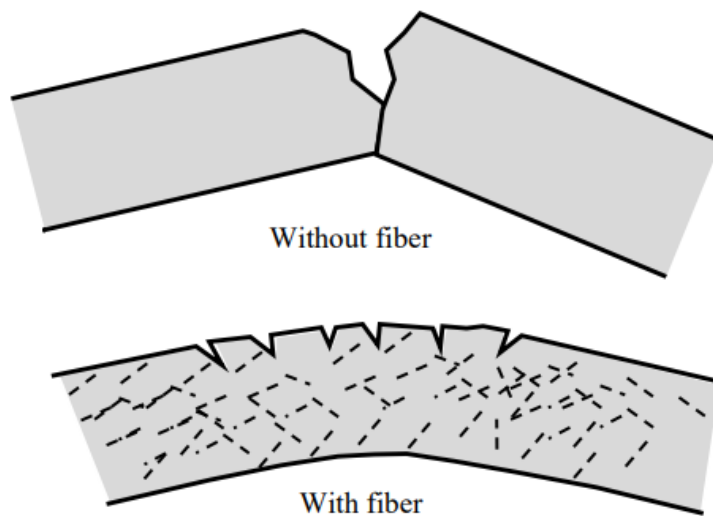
вплив волокон фібри на механізм руйнування бетону.
